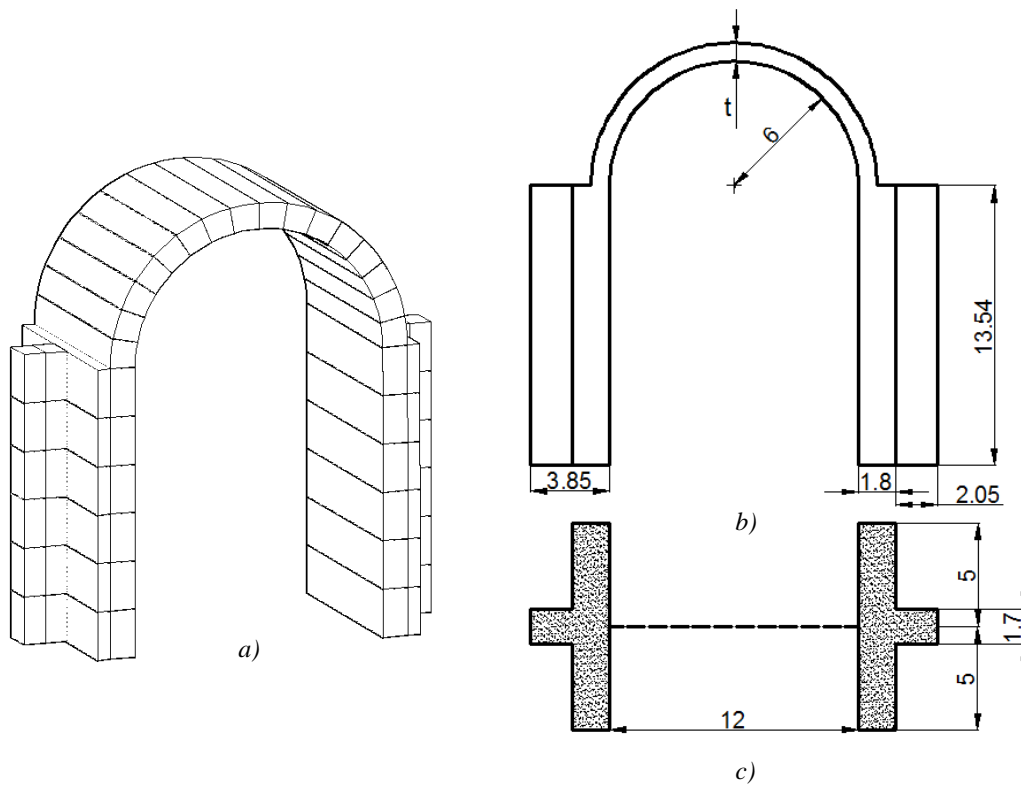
Geometría del modelo de análisis (dimensiones en metros). a) Esquema de la nave, b) Corte, c) Planta
